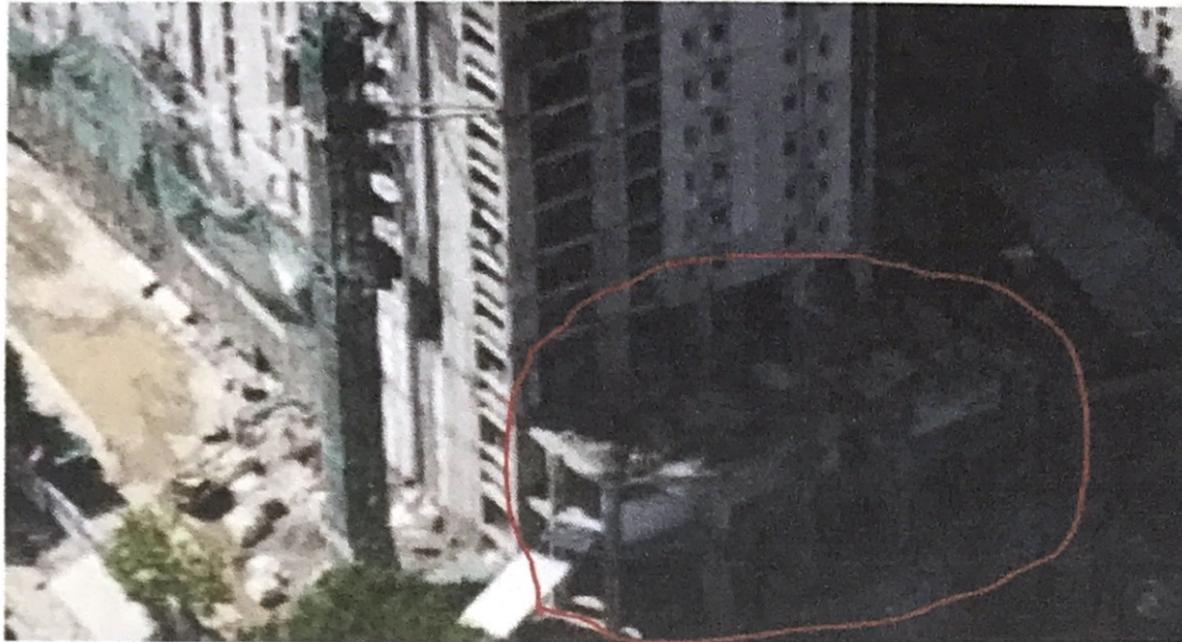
Tower 1 memiliki bentuk denah yang tidak simetris
